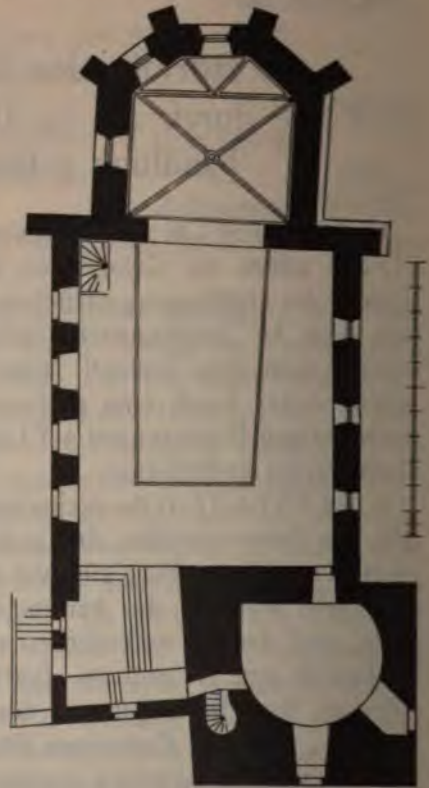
Braubach. Ehem. Kirche St. Barbara. Grundriss.
